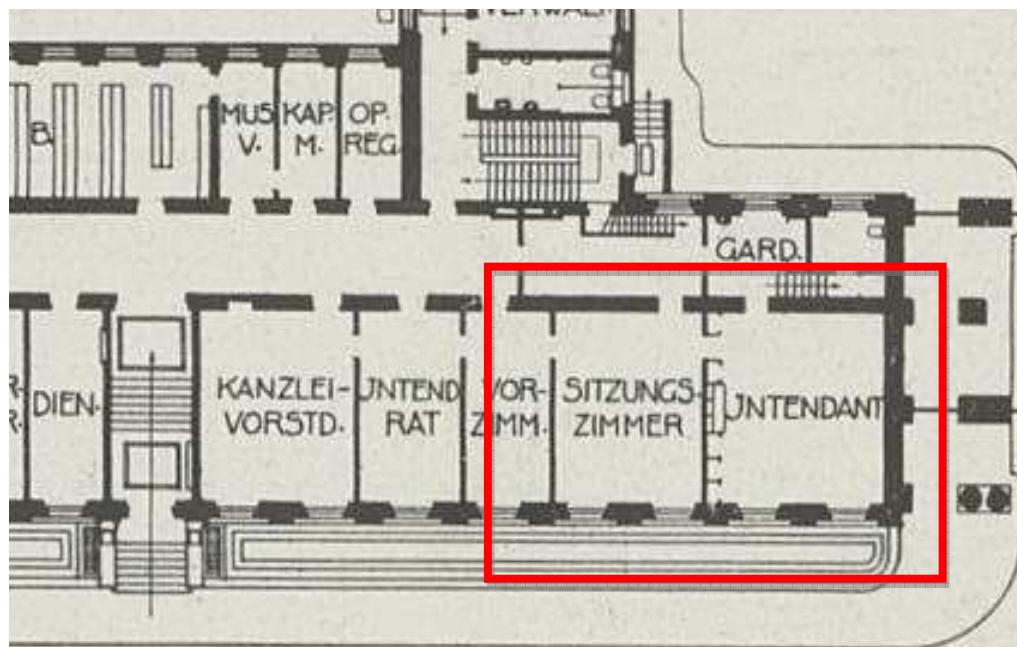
11. Ausschnitt Grundriss Hauptgeschoss
